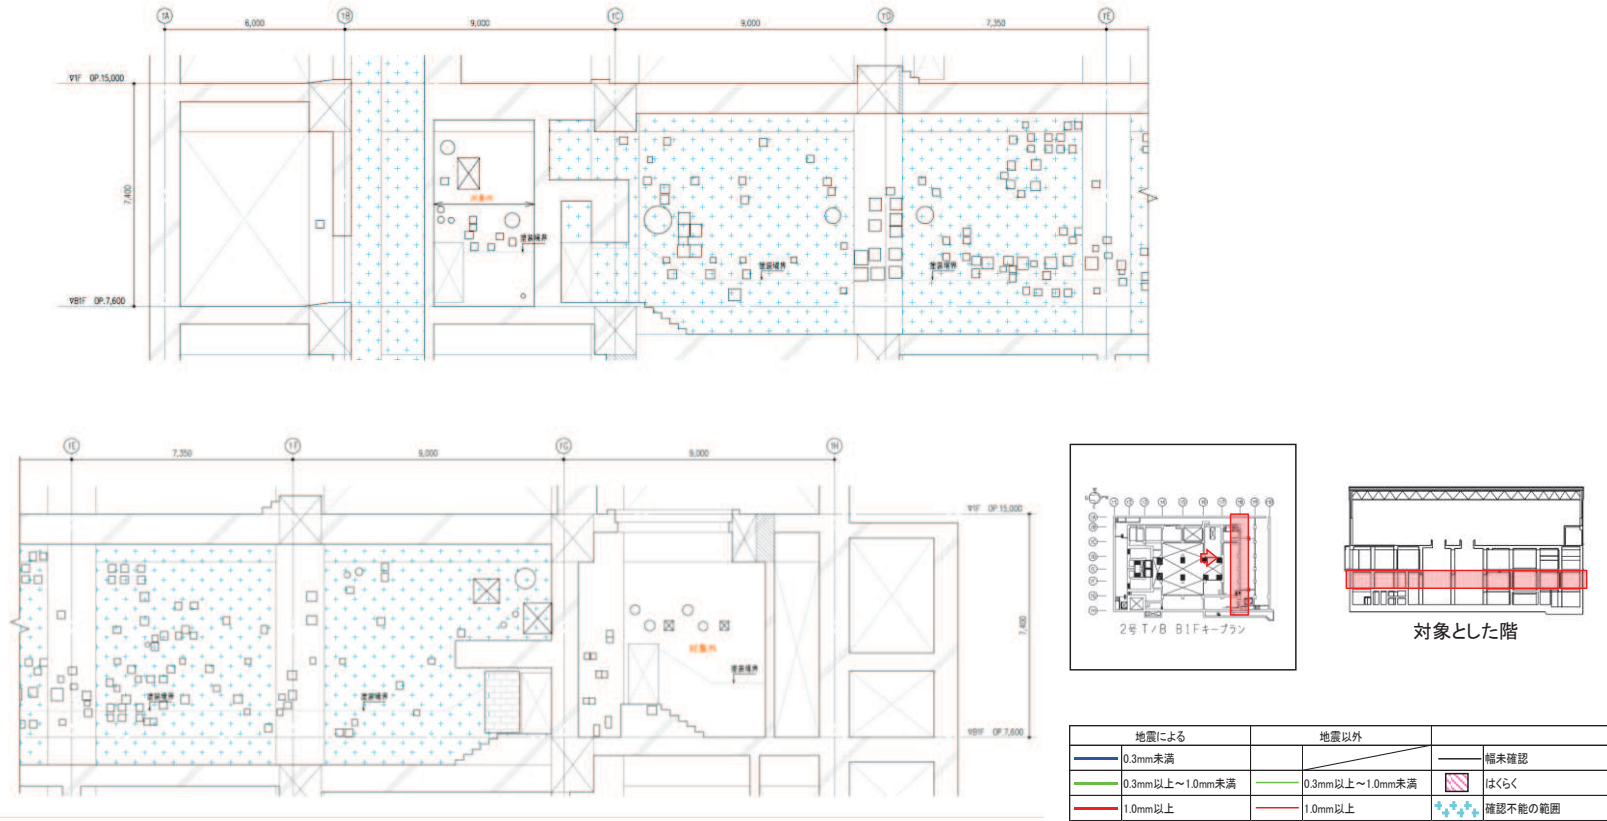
タービン建屋のひび割れ分布 耐震壁 (24) 地下 1 階 T8 通り
